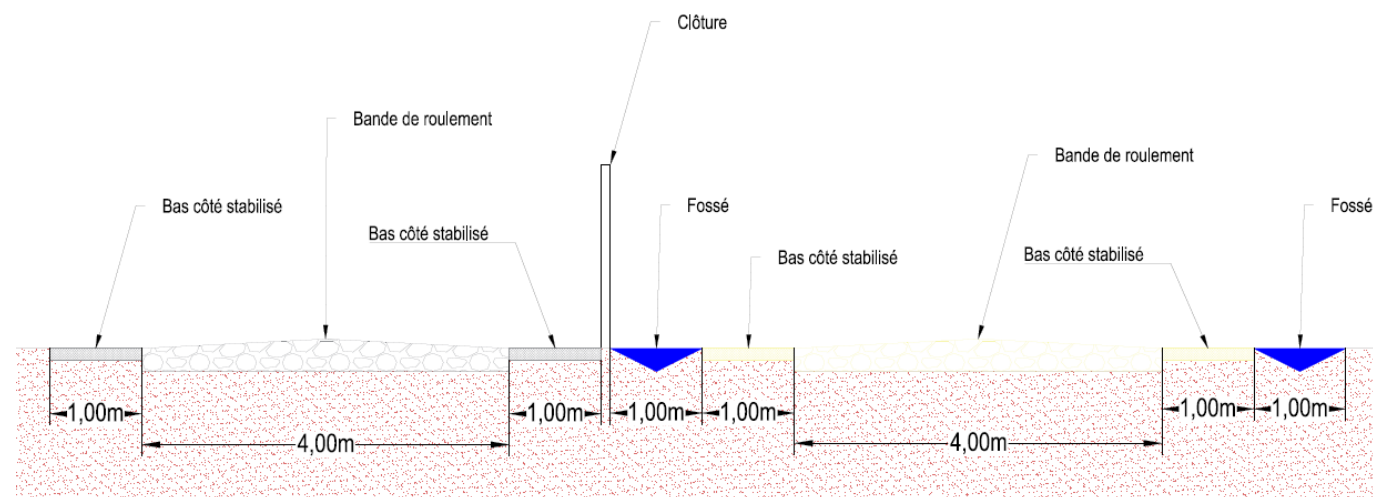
plan en coupe de la piste interne et de la piste externe
